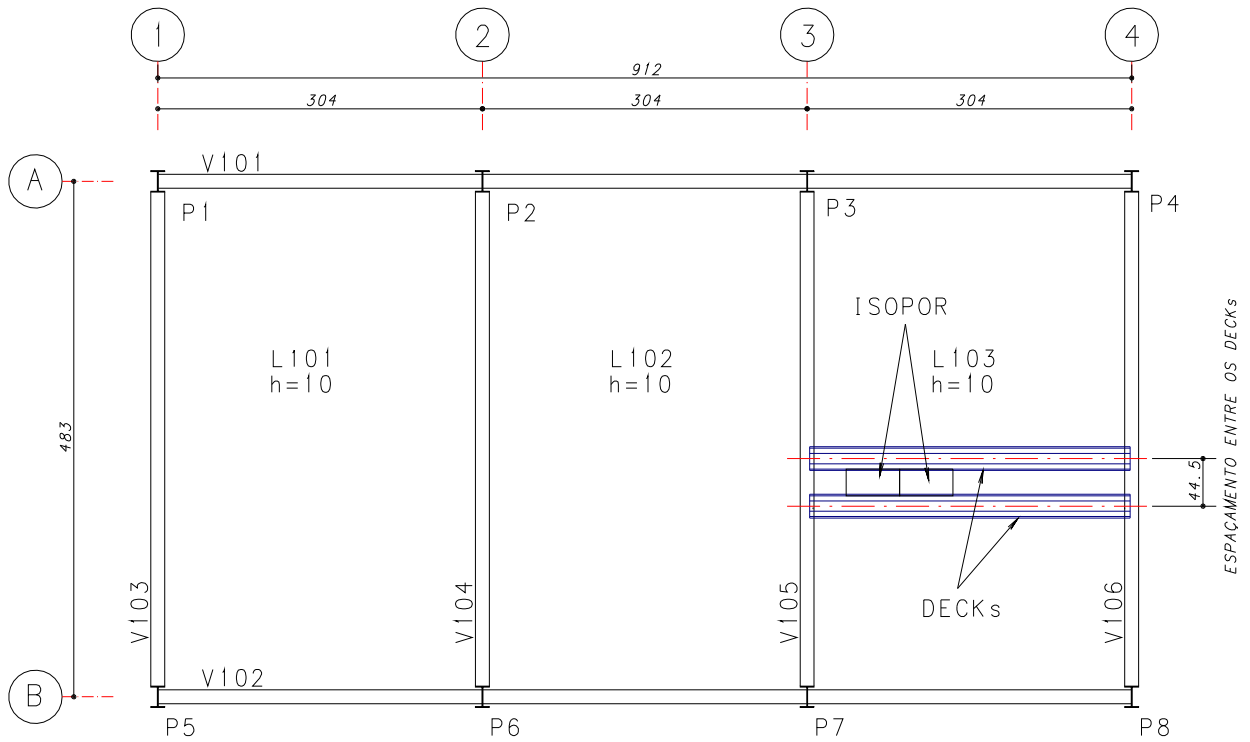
Plano de vigas para lajes com *deck* metálico
